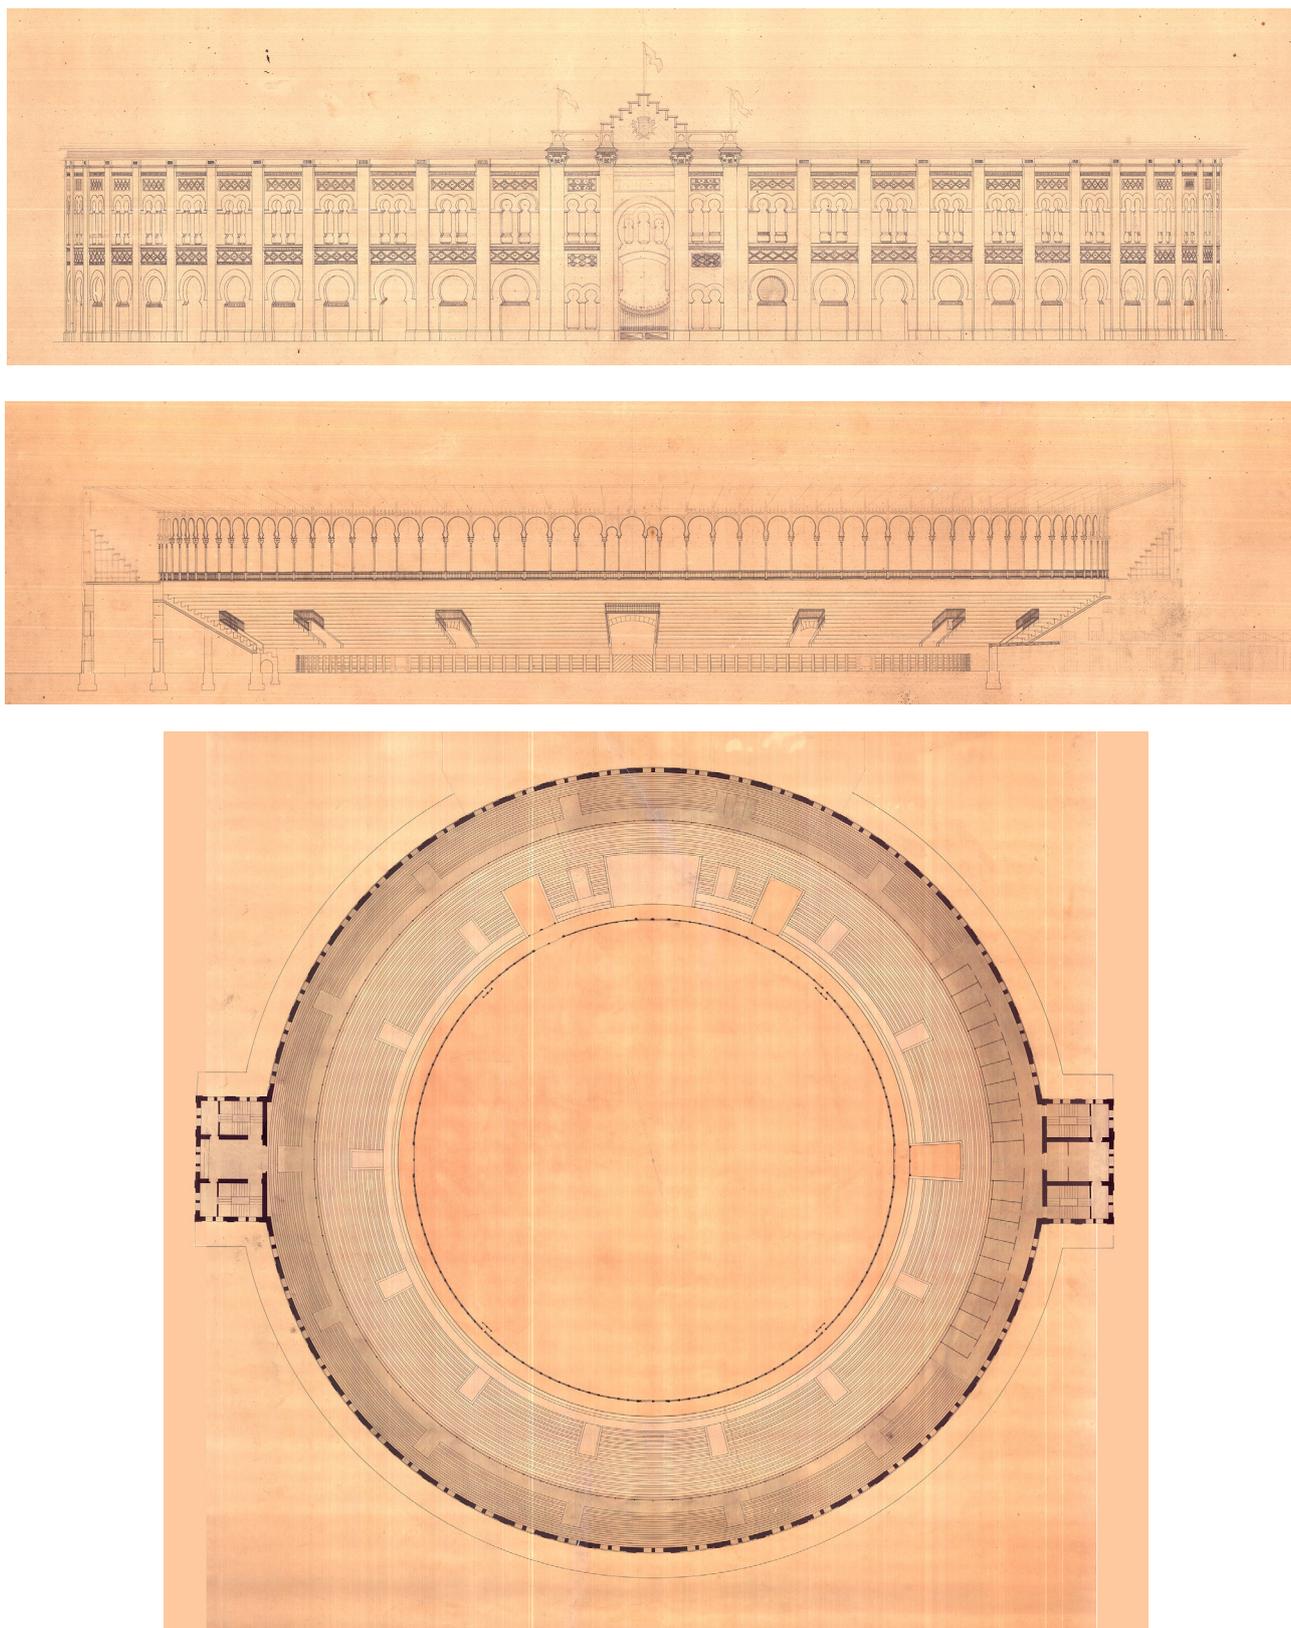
Francisco Hernández Rubio. Alzado, sección y planta de la plaza de toros no construida en Jerez de la Frontera. 1893.
